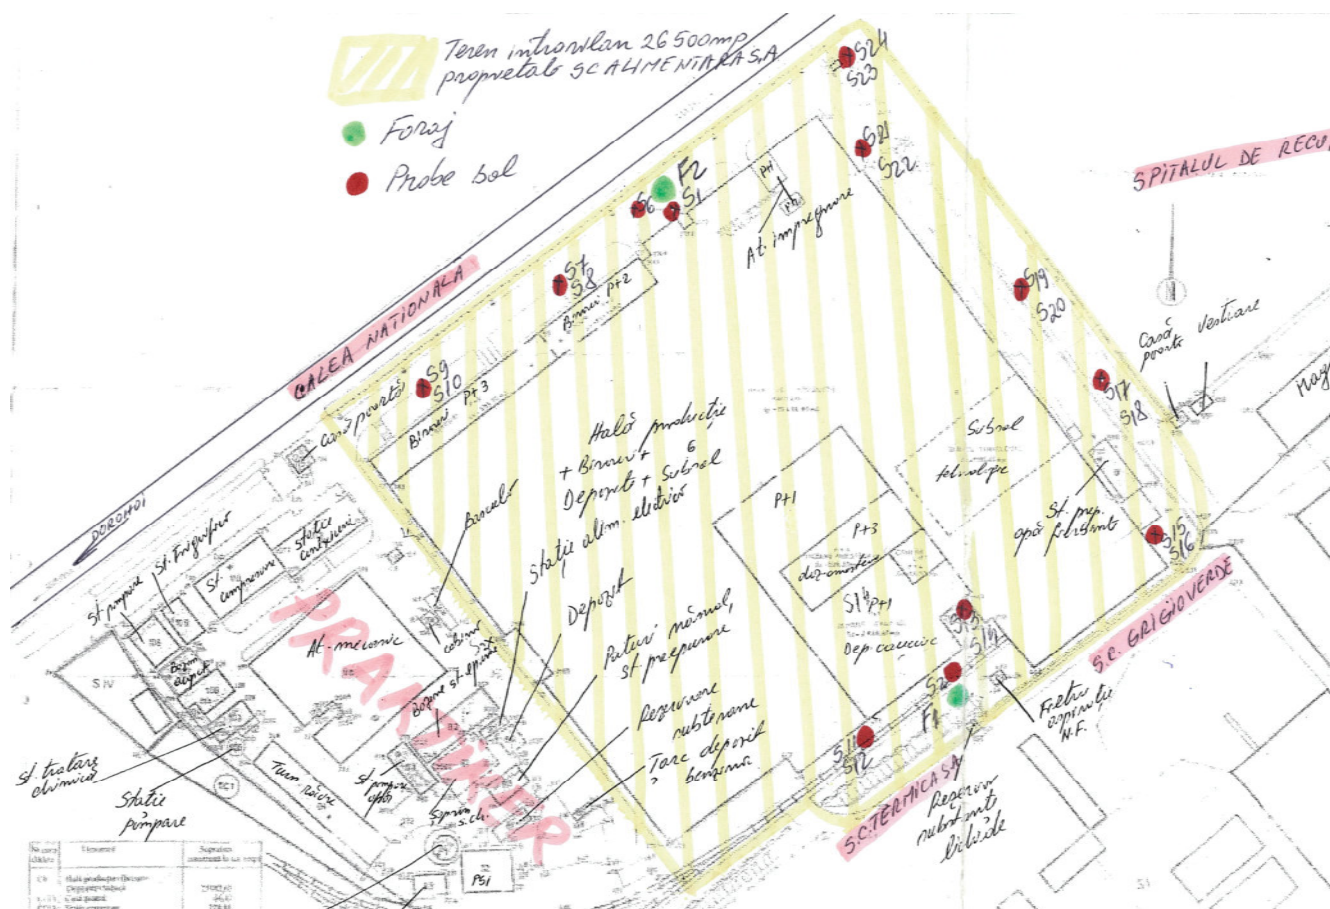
Plan de situație cu puncte de prelevare decembrie 2009
